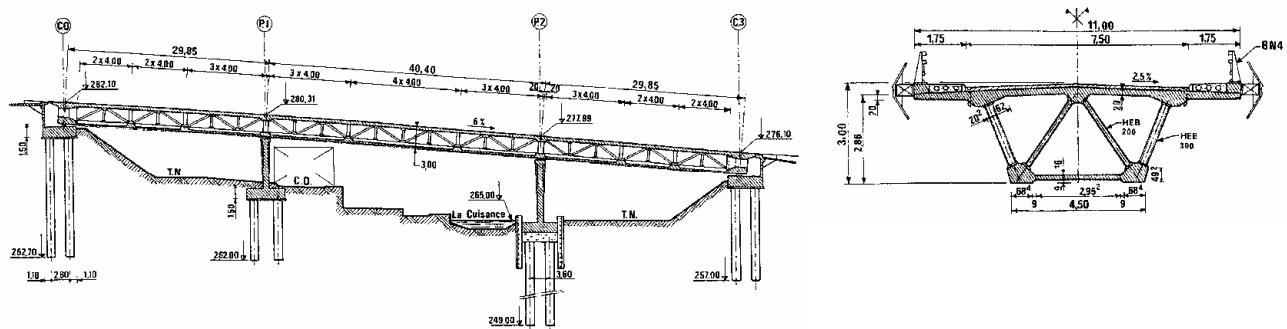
Puente de Arbois, alzado y sección transversal. (Virlogeux, 1987: 19)
